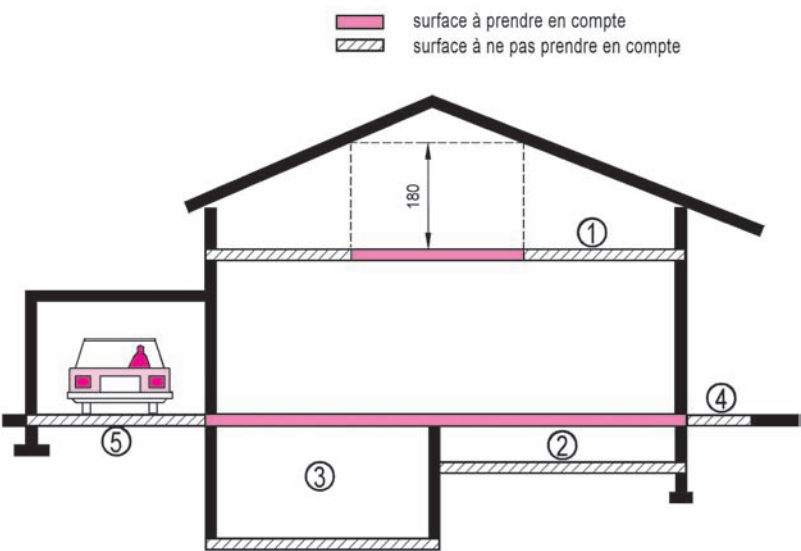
Coupe schématique sur sous-sol, rez-de-chaussée et combles
